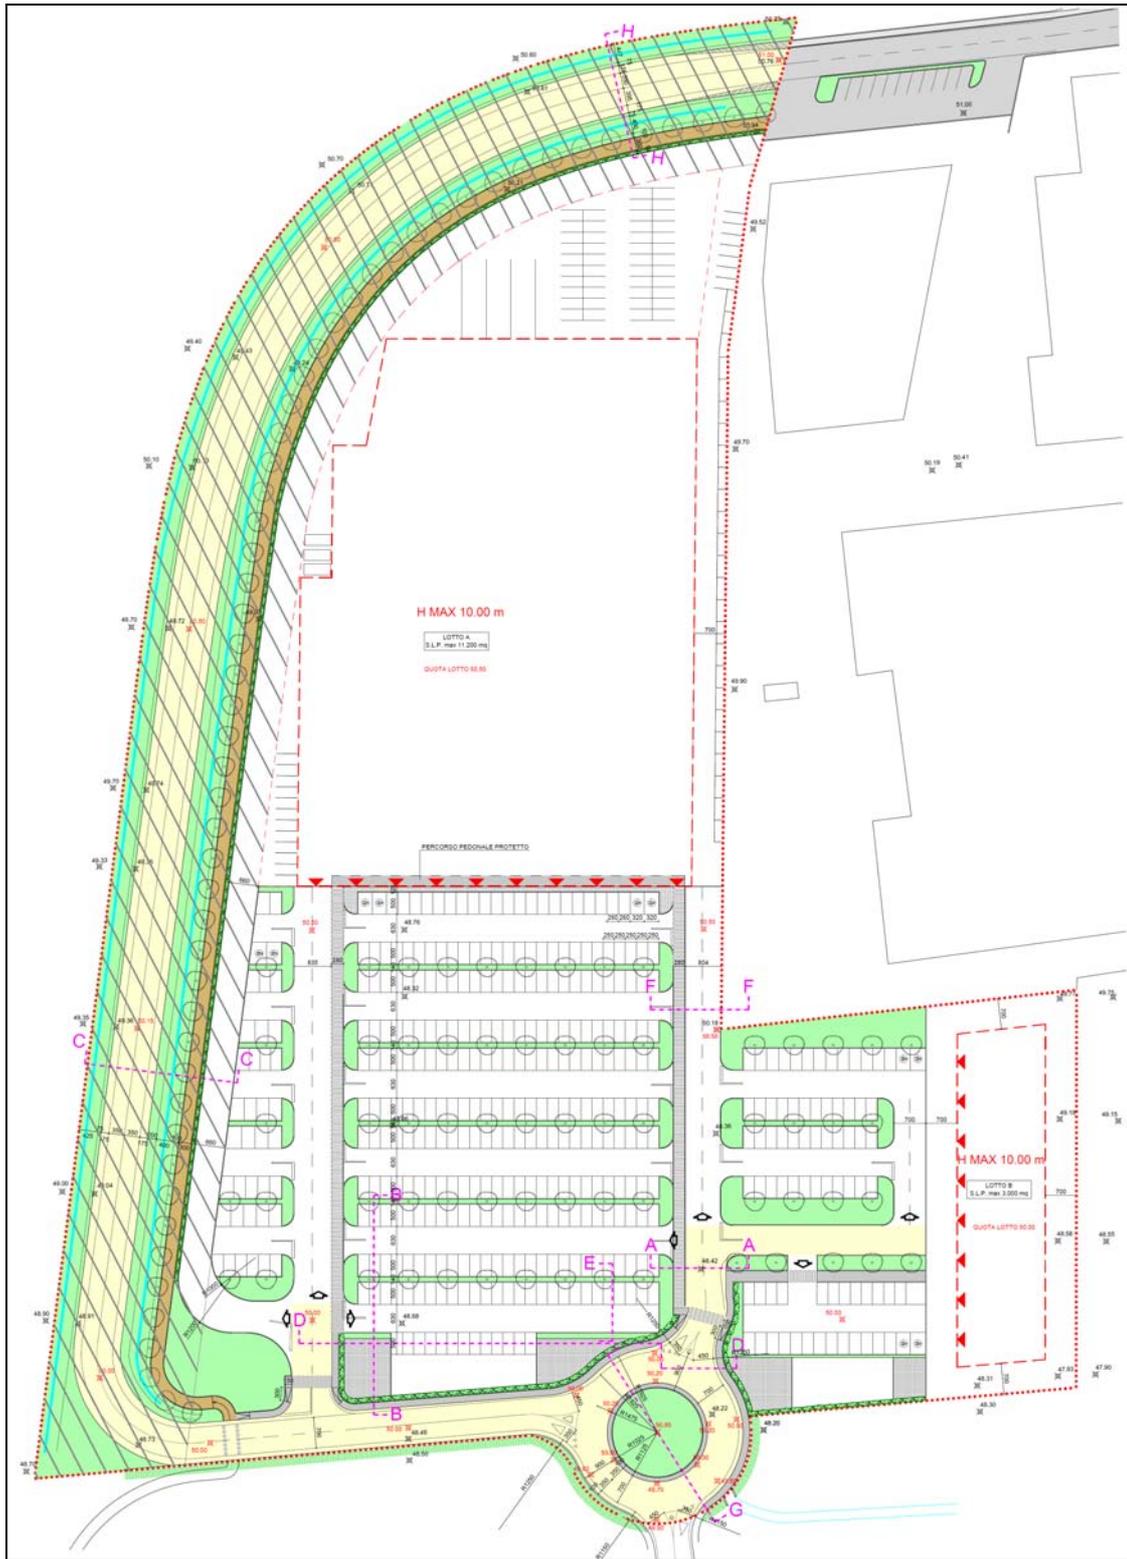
Estratto della Tavola 04: planimetria di progetto
